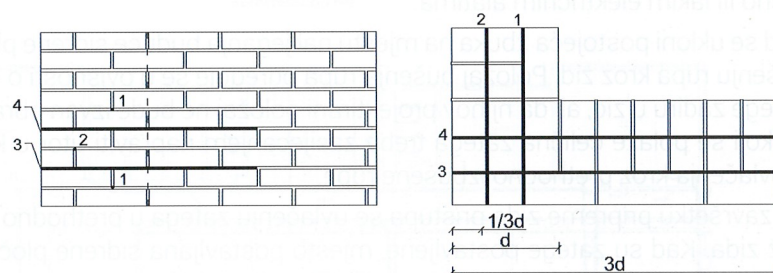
Primjer injektiranja pukotina u zidanoj konstrukciji
